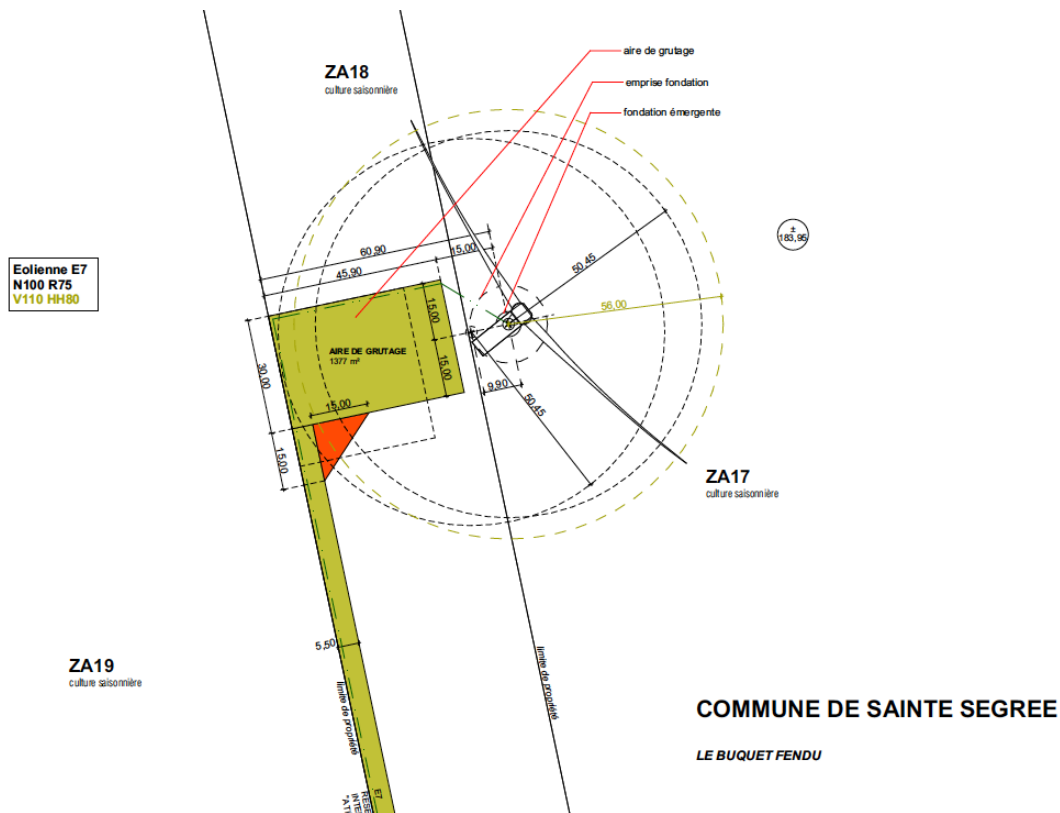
Extrait du plan architectural du PAC de mai 2021
